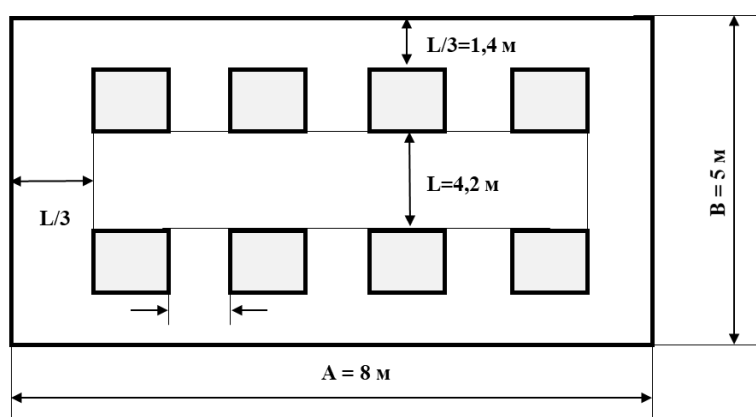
План помещения и размещения светильников с люминесцентными лампами
